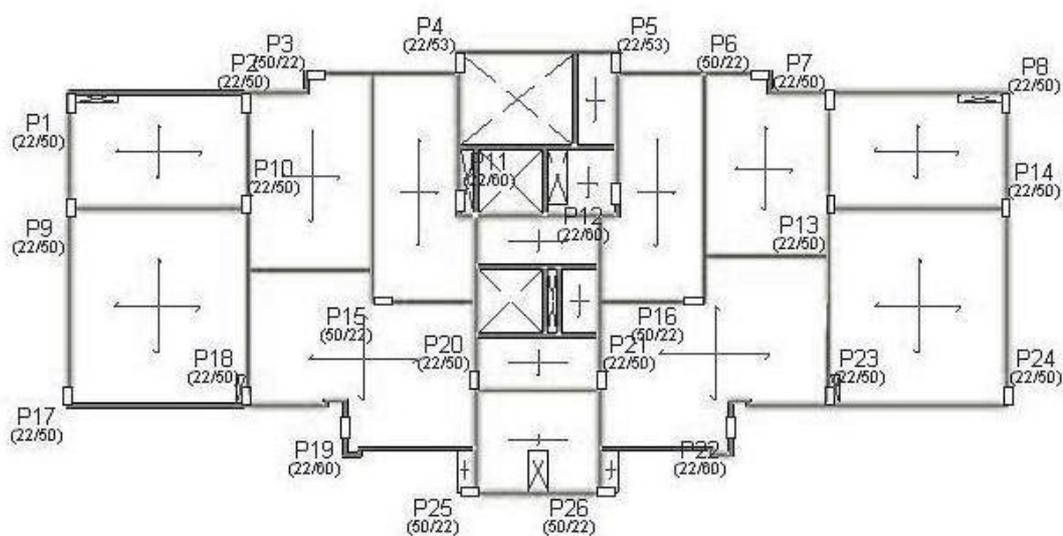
Dimensão dos Pilares - Concreto de Alto Desempenho Fonte: Software-Cypecad.
